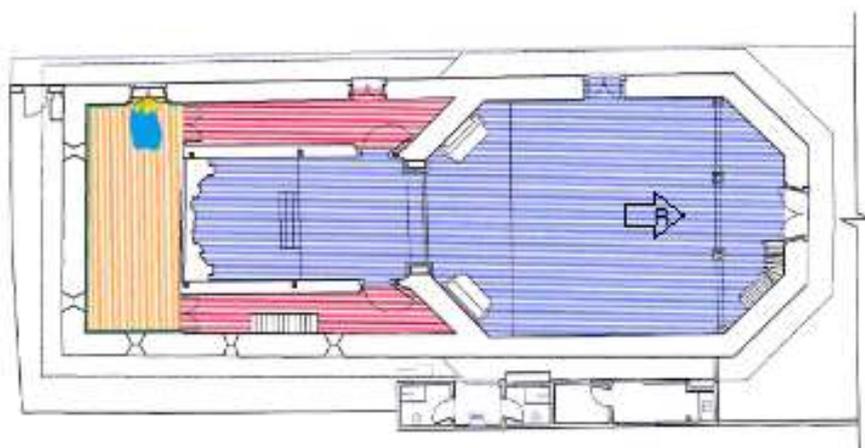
Vista B –Arcos sob coro - Planta pavimento inferior Capela do Pilar. Sem escala.
